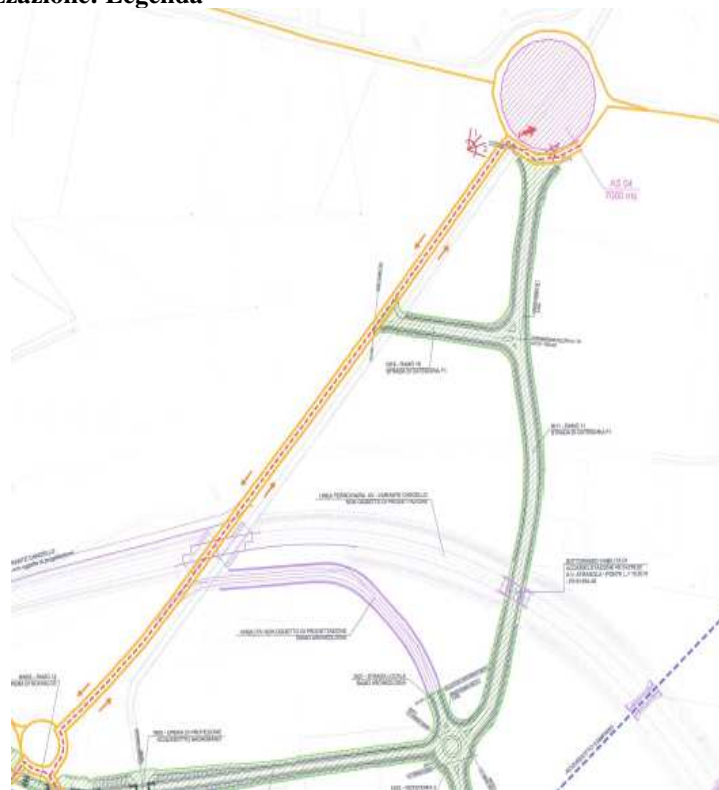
Cantierizzazione: Area di Stoccaggio AS04.
